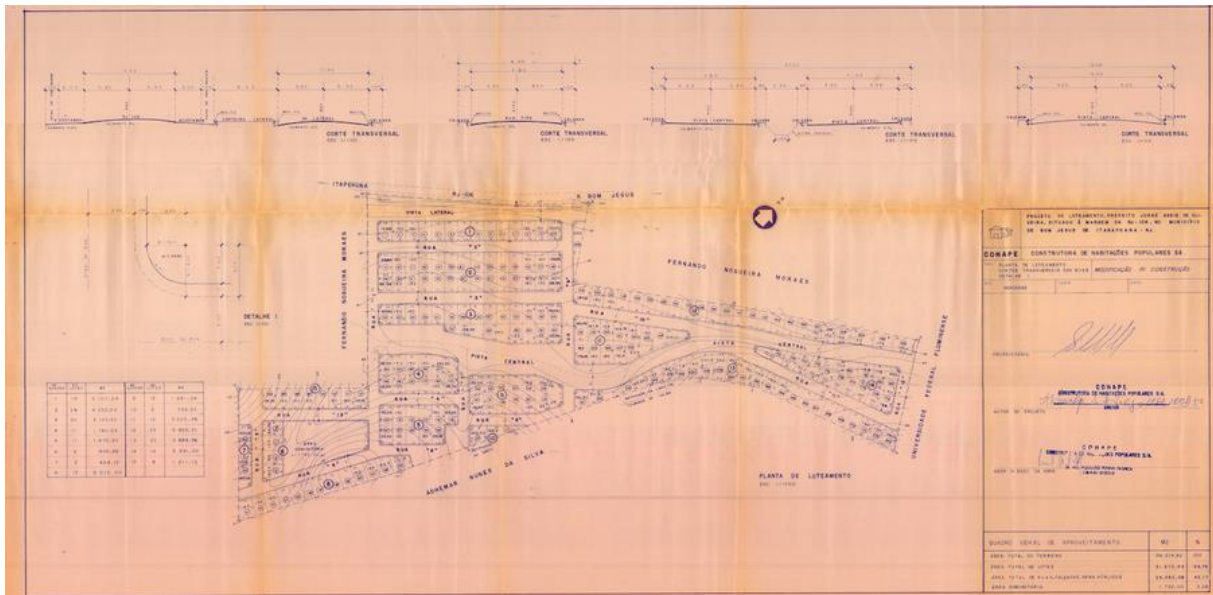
Planta de Loteamento do Asa Branca (1984).
